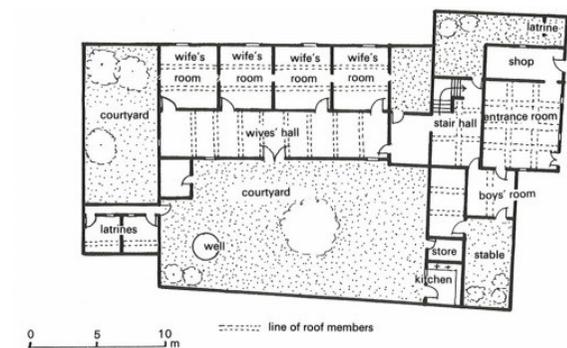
Hausa-Grundrissplan in Kano, 1950
